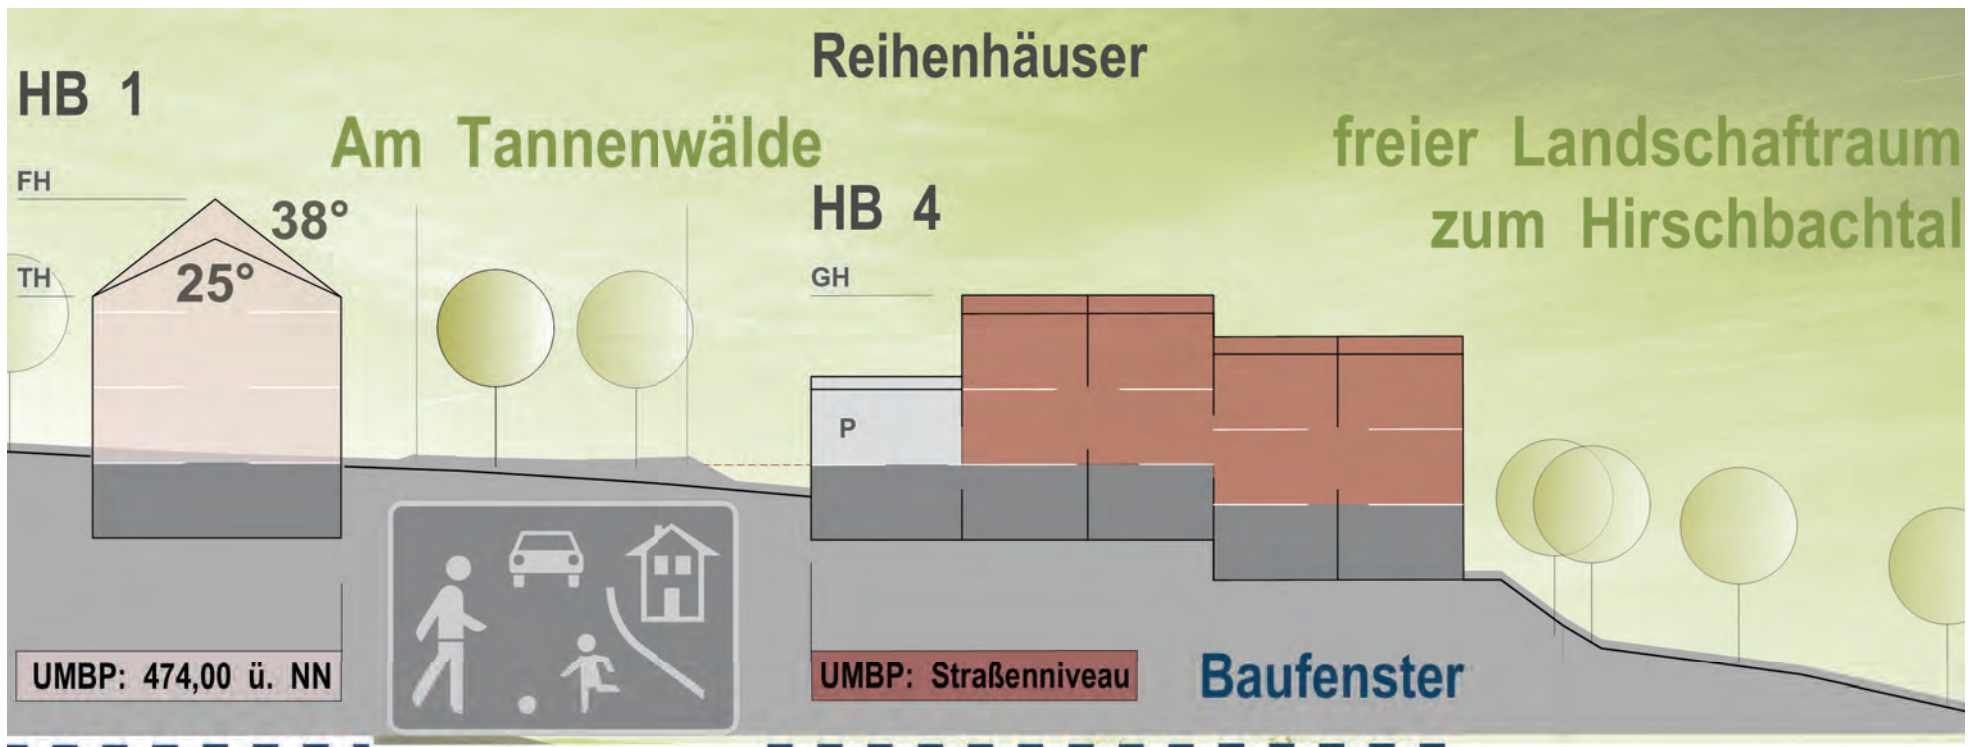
Prinzipdarstellung Höhenlage der Gebäude
